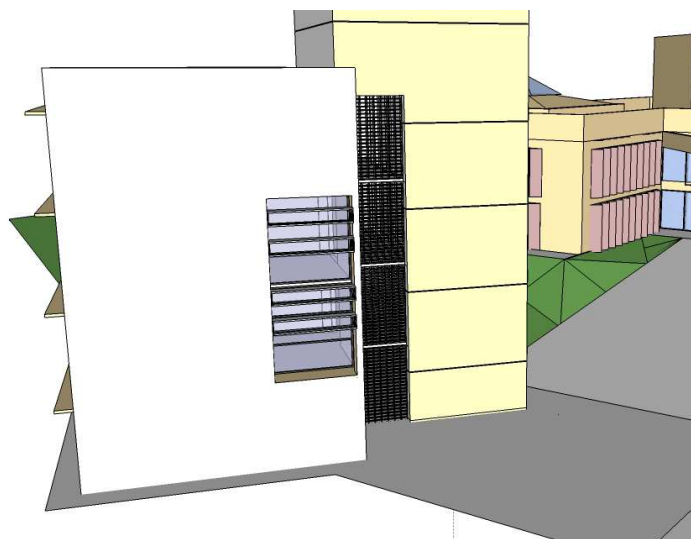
Elementos "caixa" rebaixados em quarenta centímetros em relação às vigas, vistos em perspectiva.
